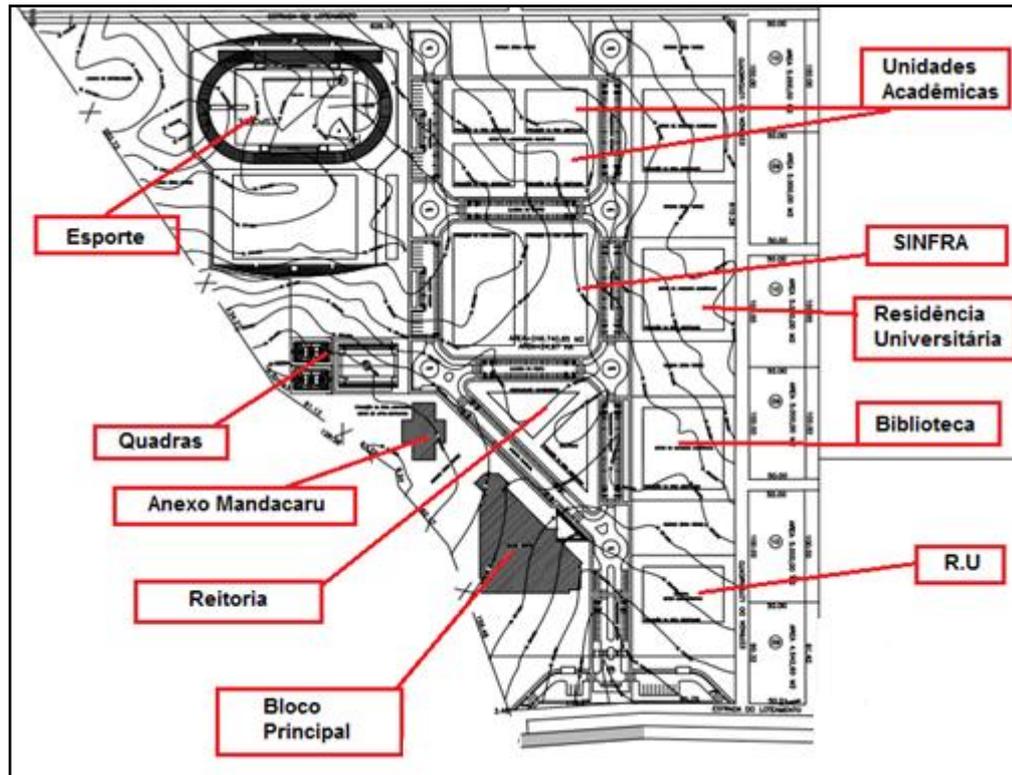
Planta Diretora da Ufal - Campus do Sertão.
